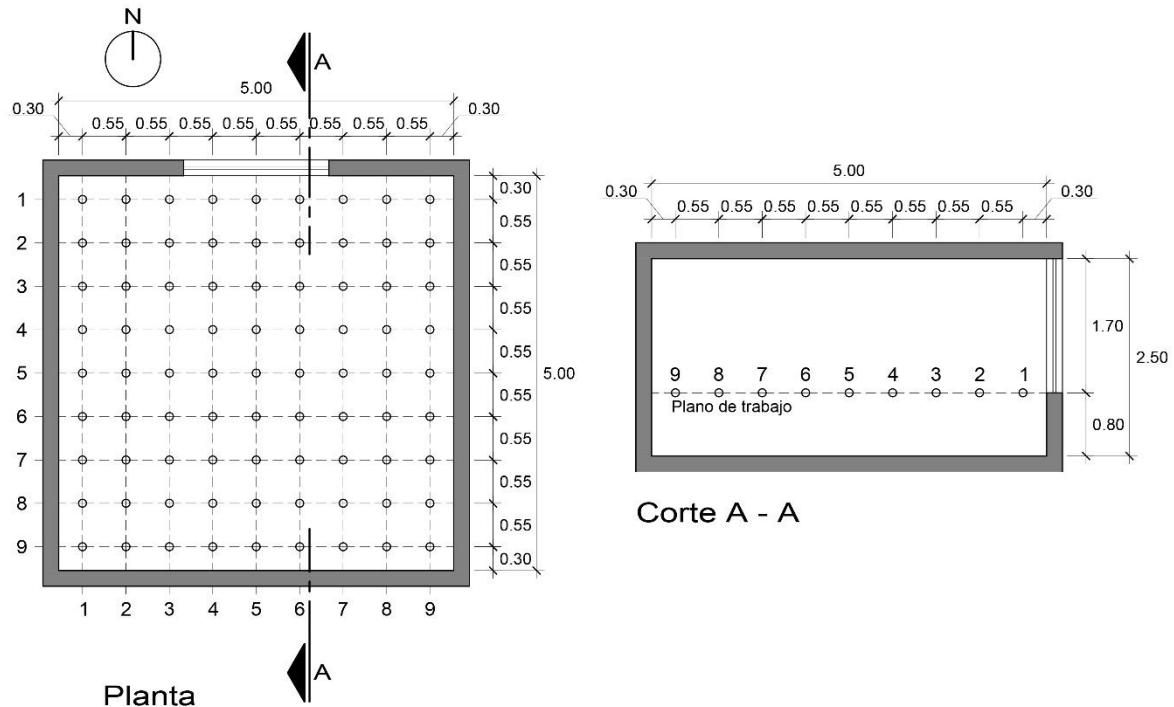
Planta y corte del recinto con la trama de medición. Fuente: Elaboración propia.
